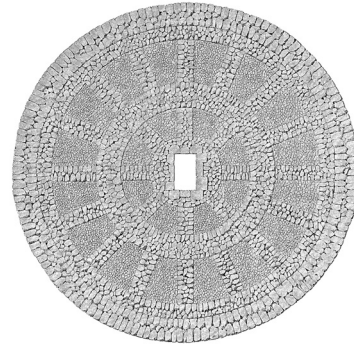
Tantalos Mezarı Plan (Texier 1849: Pl. 130)
